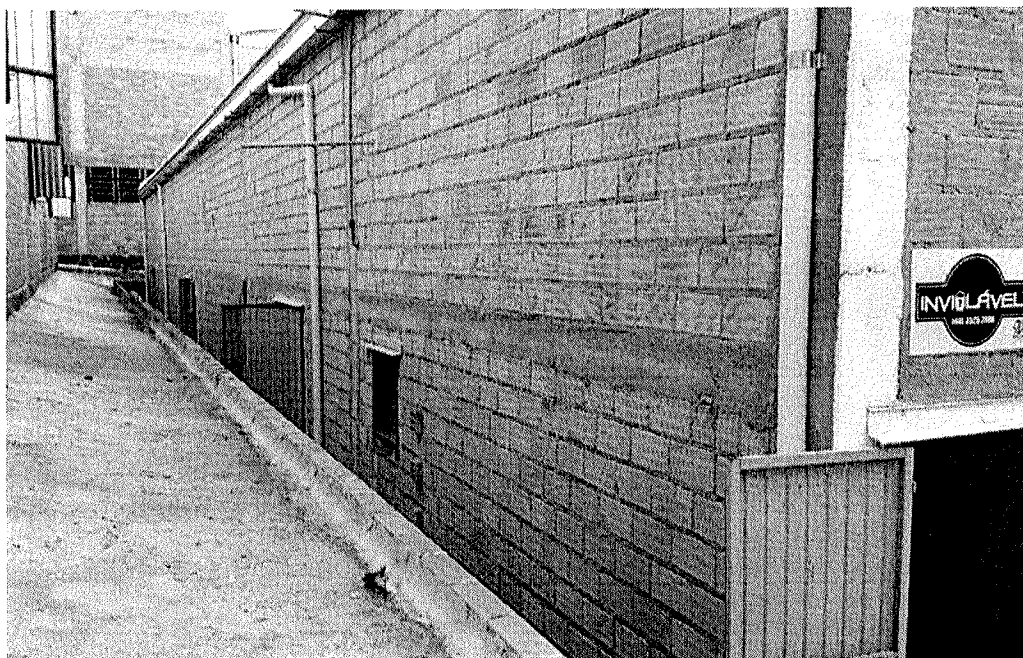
Vista lateral esquerda do barracão. Fonte: Equipe Ideal, 2019.
